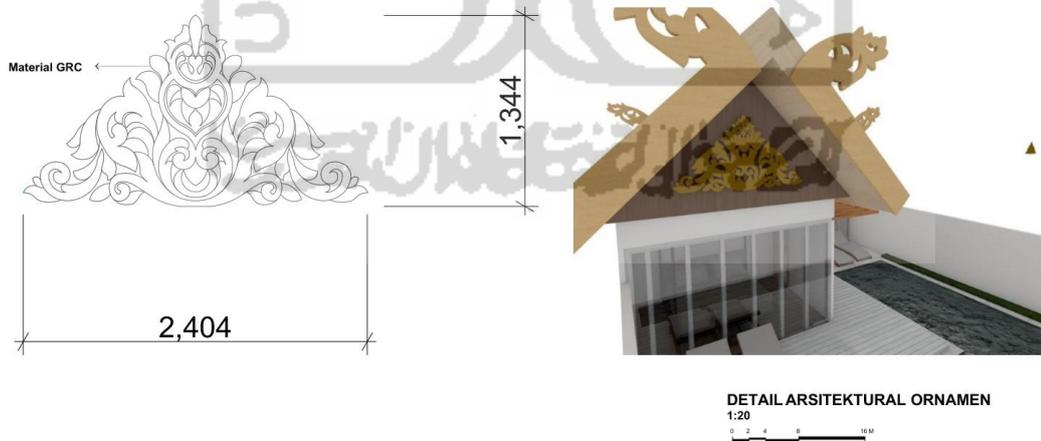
16 Detail Arsitektur Ornamen Lobby
